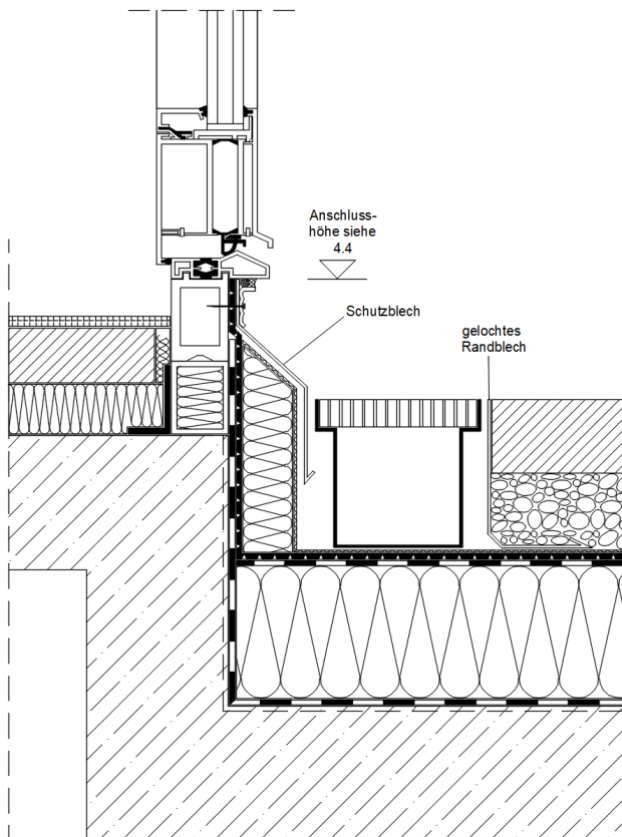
Terrassentüranschluss – Ausführung mit Flüssigkunststoff und Schutzblech –
